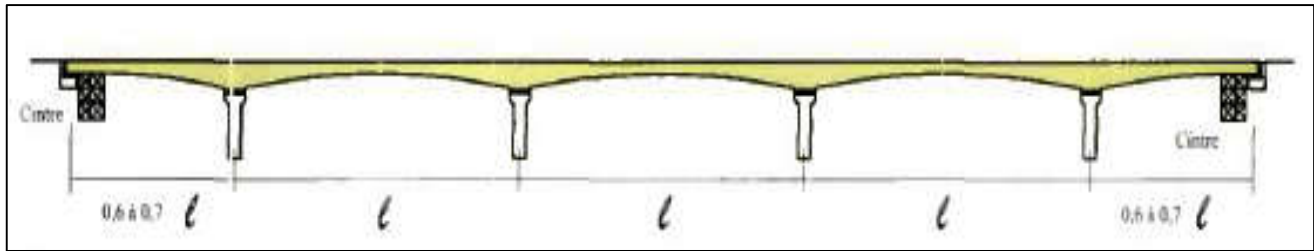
Disposition des portées d'un pont simple construit par encorbellement
